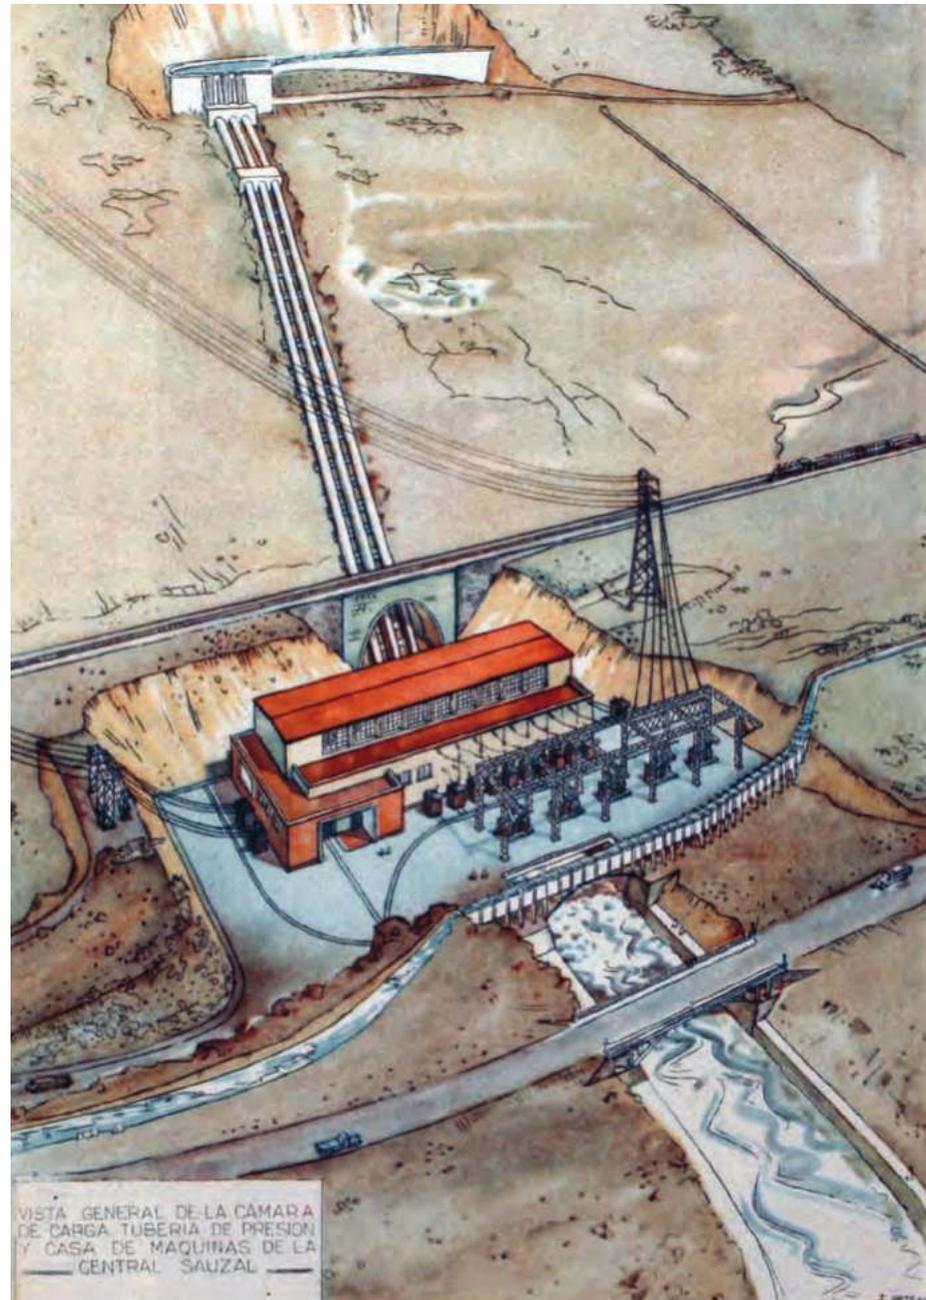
Ilustración de vista general de la cámara de carga, tubería de presión y casa de máquinas de central Sauzal.
